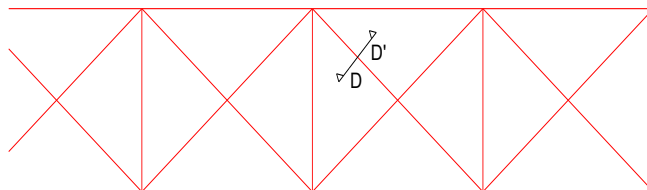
Trecho de planta identificando a posição do corte DD'
